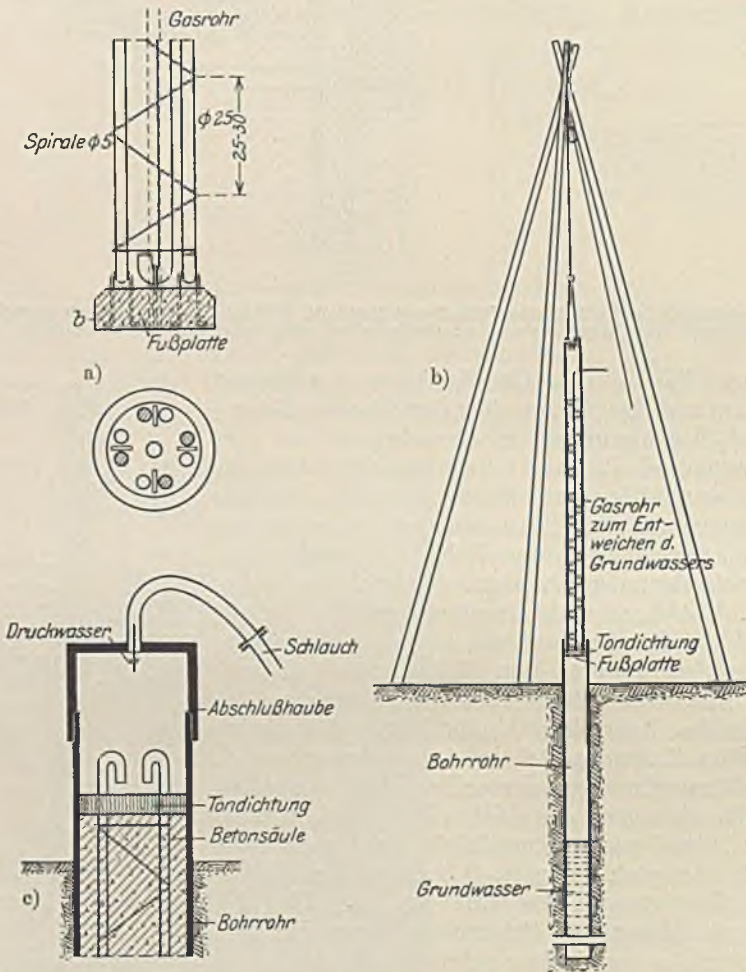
a. Fußplatte mit ansetzender Bewehrung.
